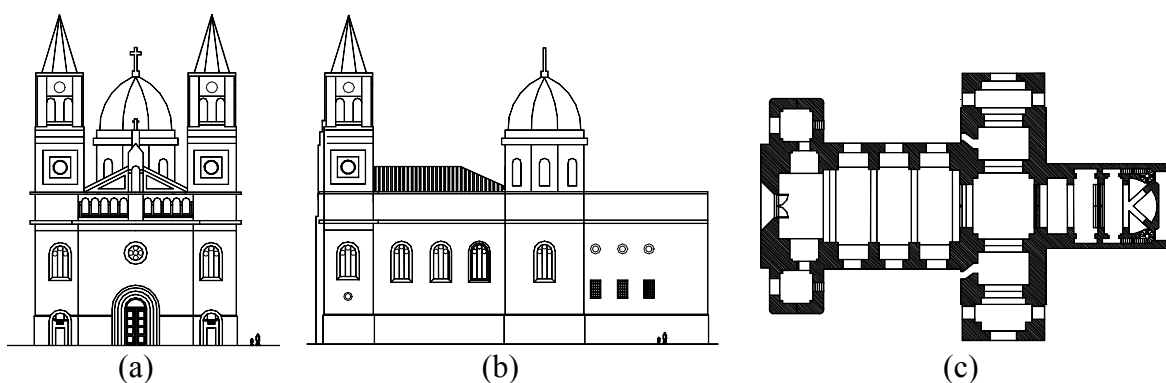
Peças desenhadas: (a) fachada, (b) alçado lateral direito e (c) planta
